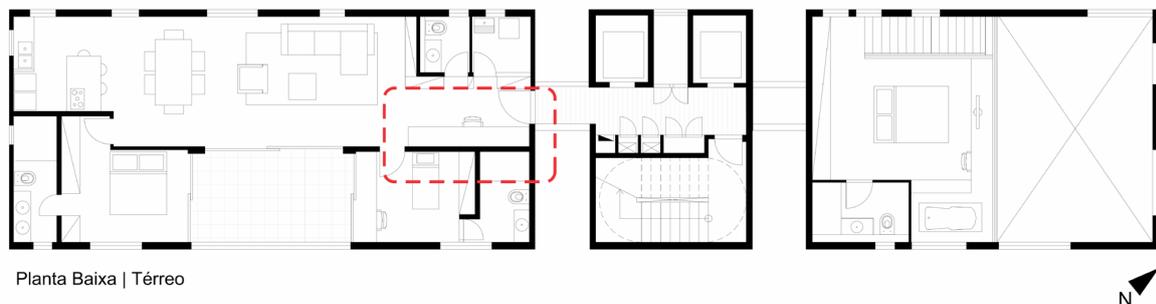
Planta baixa do pavimento tipo com destaque para a área de trabalho produtivo no edifício Fidalga.
